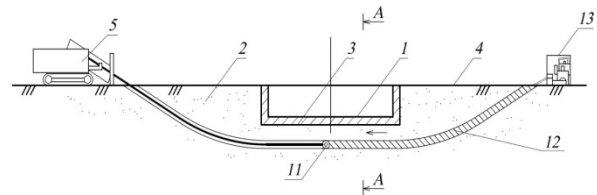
Повздовжній переріз екрана: 1-споруда; 2-ґрунт; 3-підосва споруди; 4-денна поверхня; 5-бурова установка; 11-двонаправлений шнек; 12-подача твердіючого розчину; 13-міксерна станція
